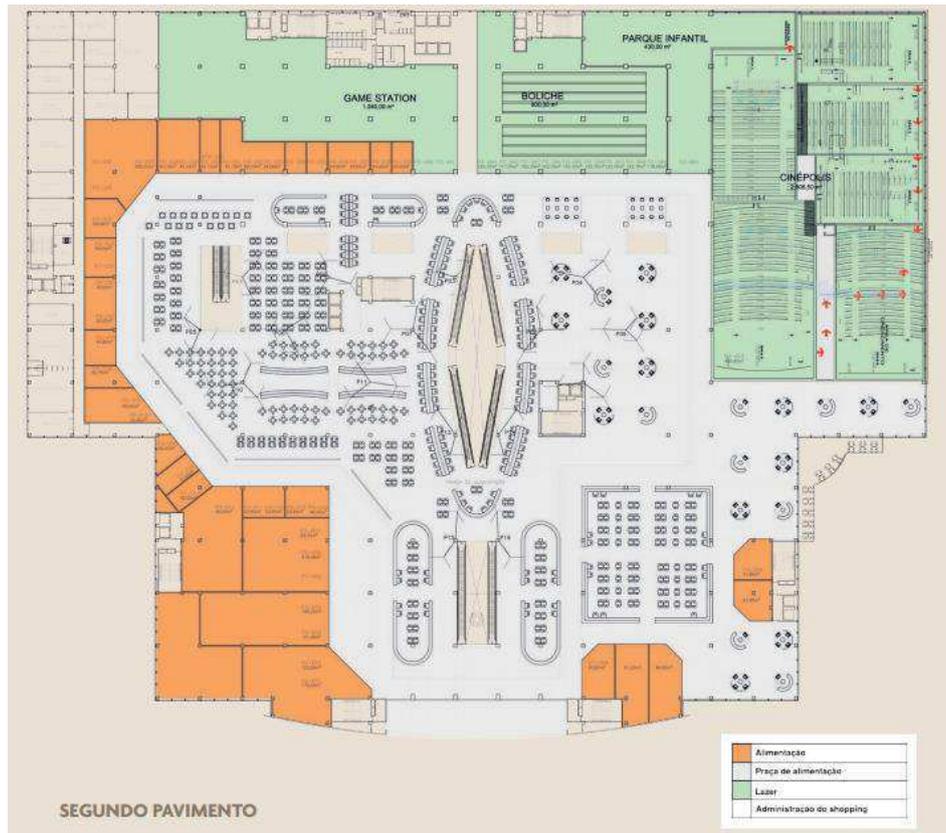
PLANTA BAIXA DO 2º PAVIMENTO – PRAÇA DE ALIMENTAÇÃO.
